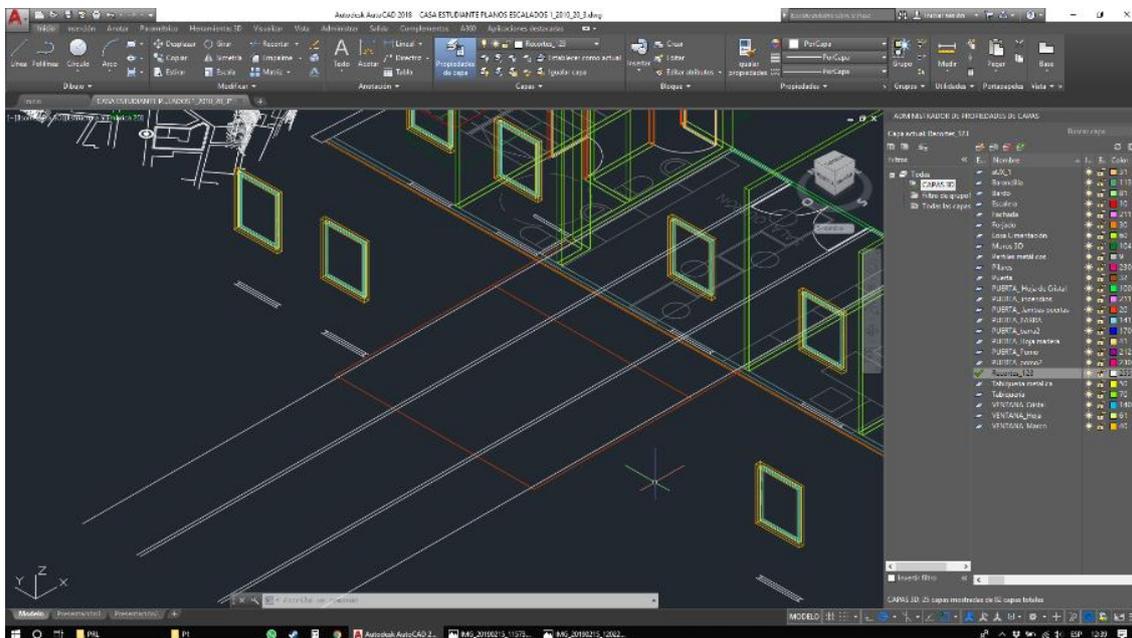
Ventanas 1ª Planta en AutoCAD. Casa del estudiante
